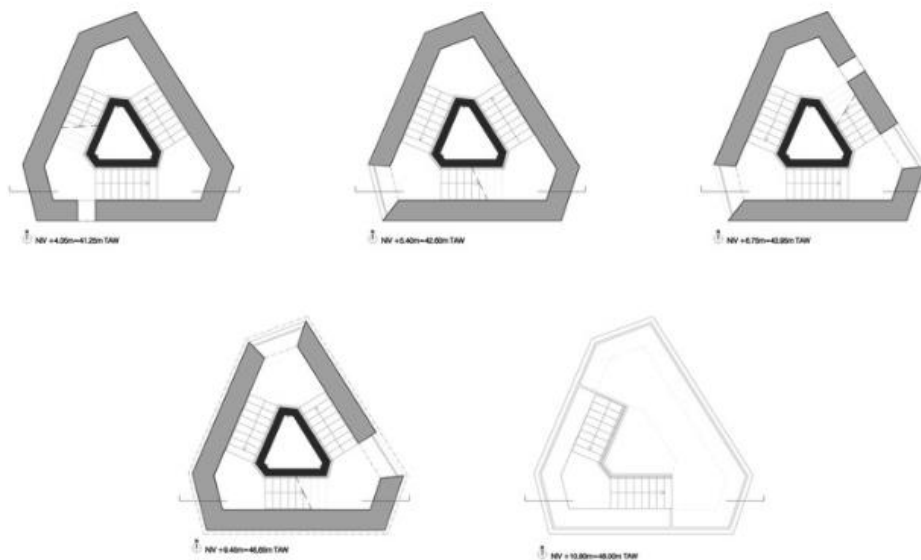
Plantas Torre de Negenoord – escadas conduzem a diferentes panorâmicas (Achdaily, 2021)
